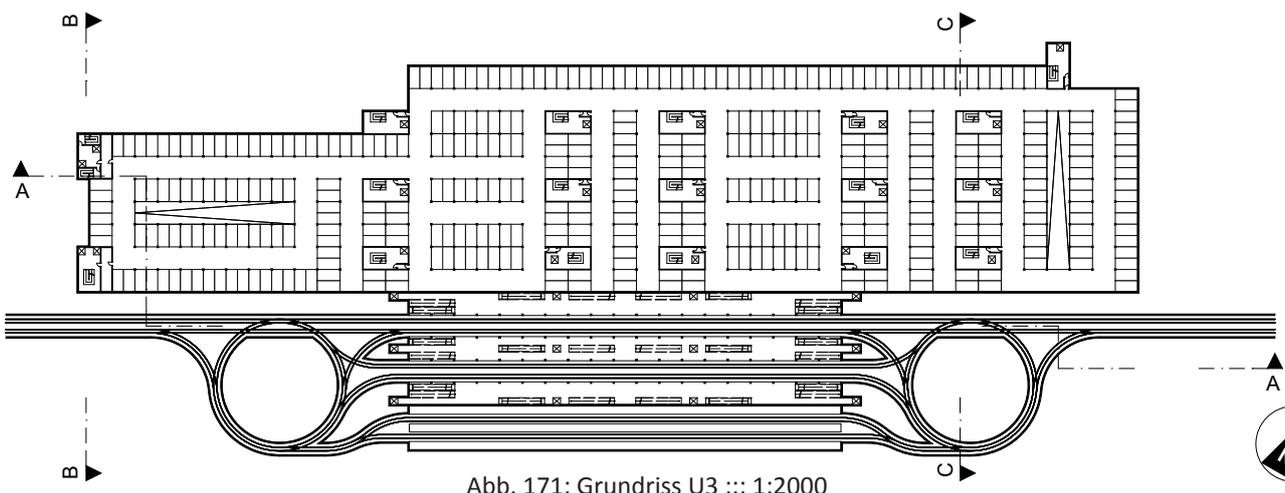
Grundriss U3 ::: 1:2000
